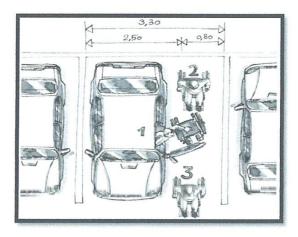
Dimension d'une place de parking pour le handicap moteur (source : site web :"Théonorme"[En ligne] http://www.theonorme.com/norme_article/caracteristiques-dimensionnelles-4/)
